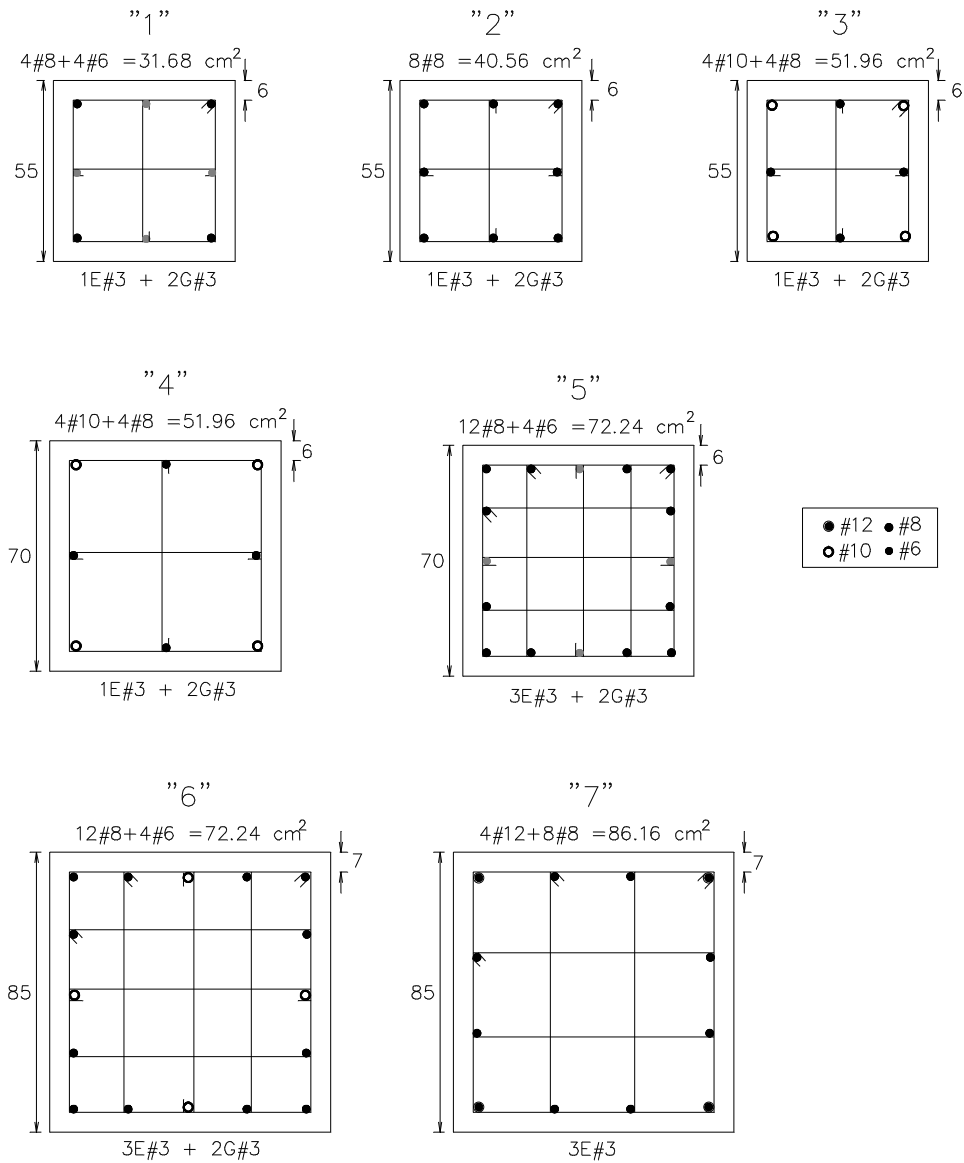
Tipos de armados propuestos para las columnas del eje 2, estructuras de 17 niveles diseñadas en zona II (RDF-93 y RDF-04)
